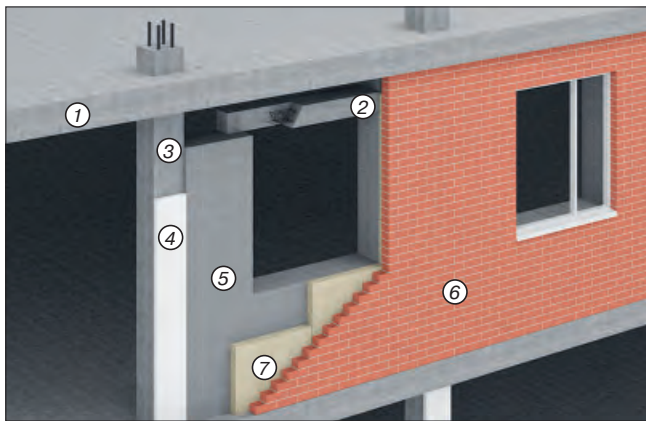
Конструкция наружной стены с полистиролбетонными перемычками: 1 – перекрытие ж/б; 2 – полистиролбетонная армированная перемычка; 3 – несущая ж/б колонна; 4 – полистирол или иной утеплитель, толщина по расчету; 5 – стеновой материал (ГС, СКЦ и т. п.); 6 – облицовочный кирпич; 7 – утеплитель. При использовании полистиролбетона не требуется
